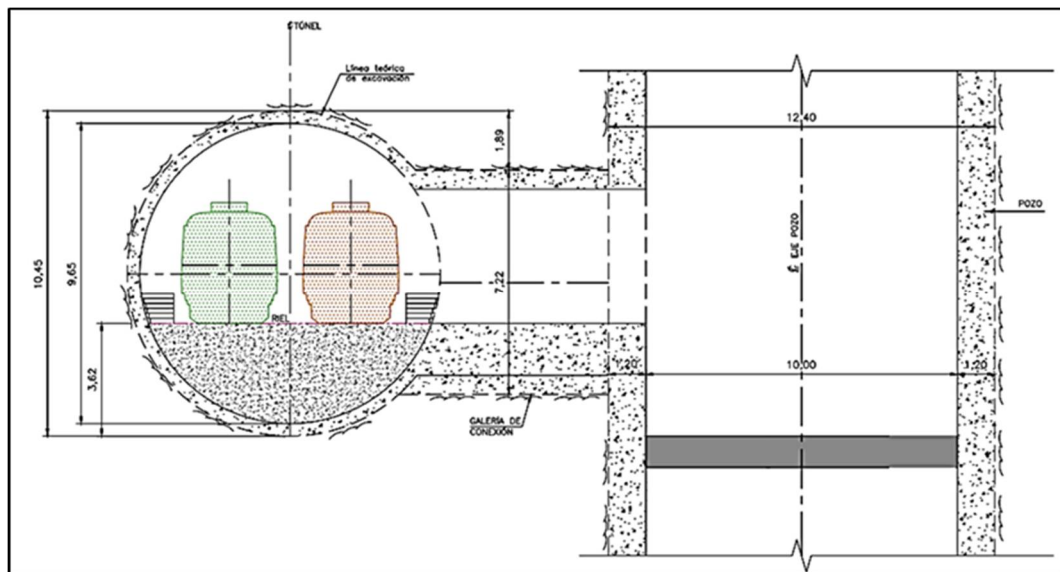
Vista longitudinal de la galería de conexión entre el pozo y el túnel
